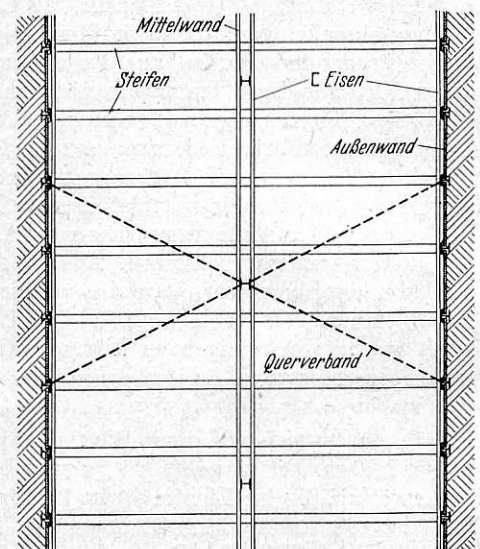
Grundriß einer zweischiffigen Baugrube mit kreuzförmigem waagrechtem Querverband.
